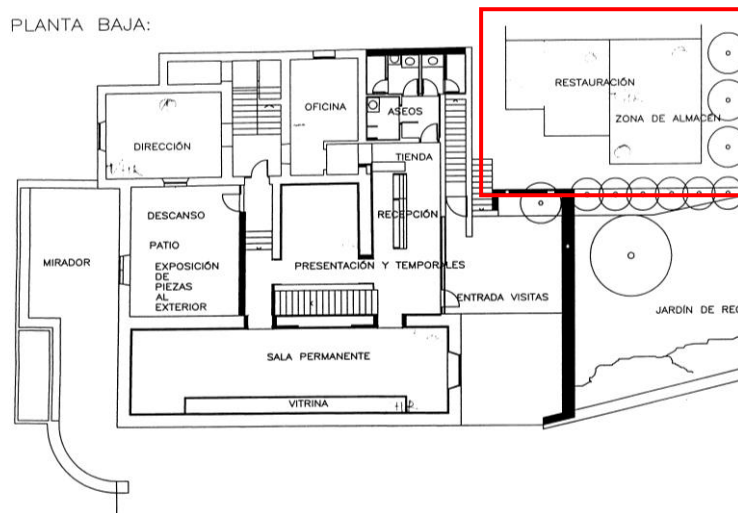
Localização do edifício de armazéns na planta do CAC.
